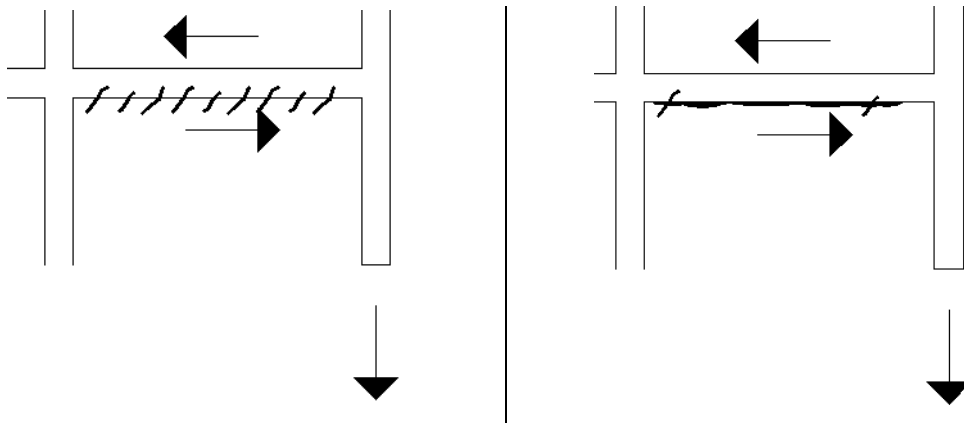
Tensões tangenciais viga/parede. No primeiro caso fissuras a 45°; no segundo caso fissura única e algumas secundárias (Modificado, Ortiz, 1983).
